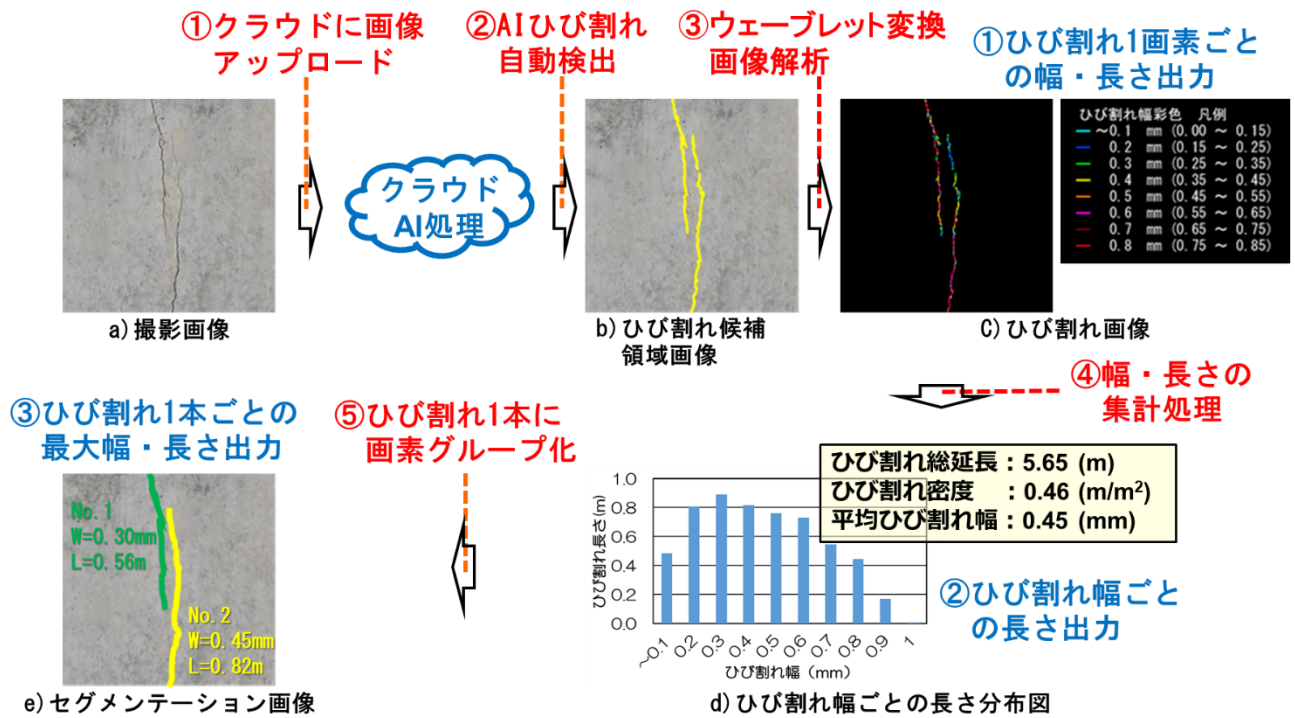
本技術によるコンクリートのひび割れ画像解析の実施手順
